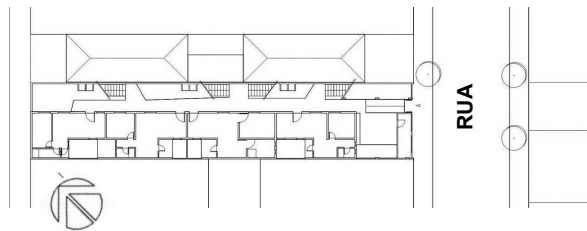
Implantação e vista do projeto Pedro Facchini (VB-02).
